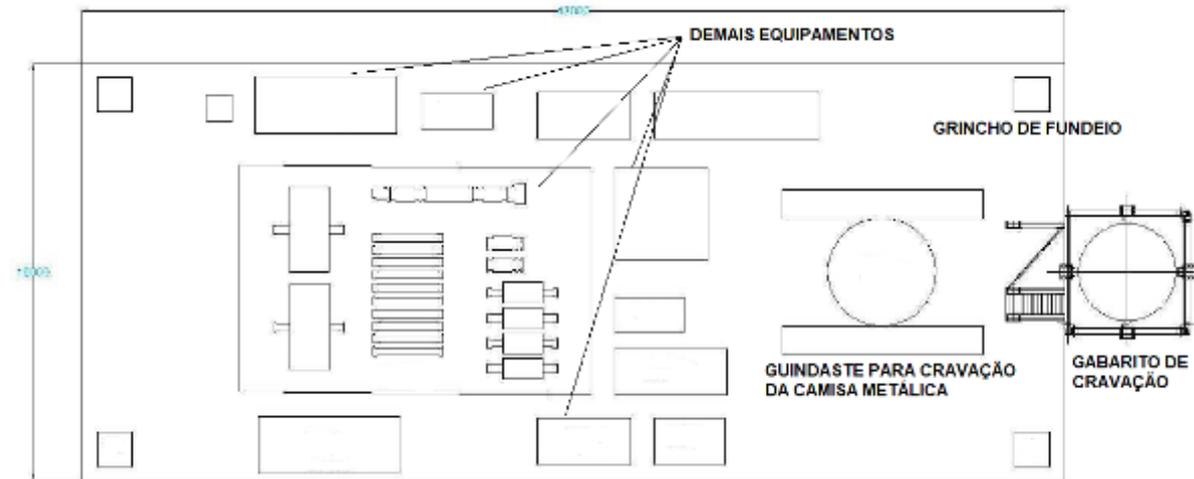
Disposição esquemática dos equipamentos sobre a balsa
